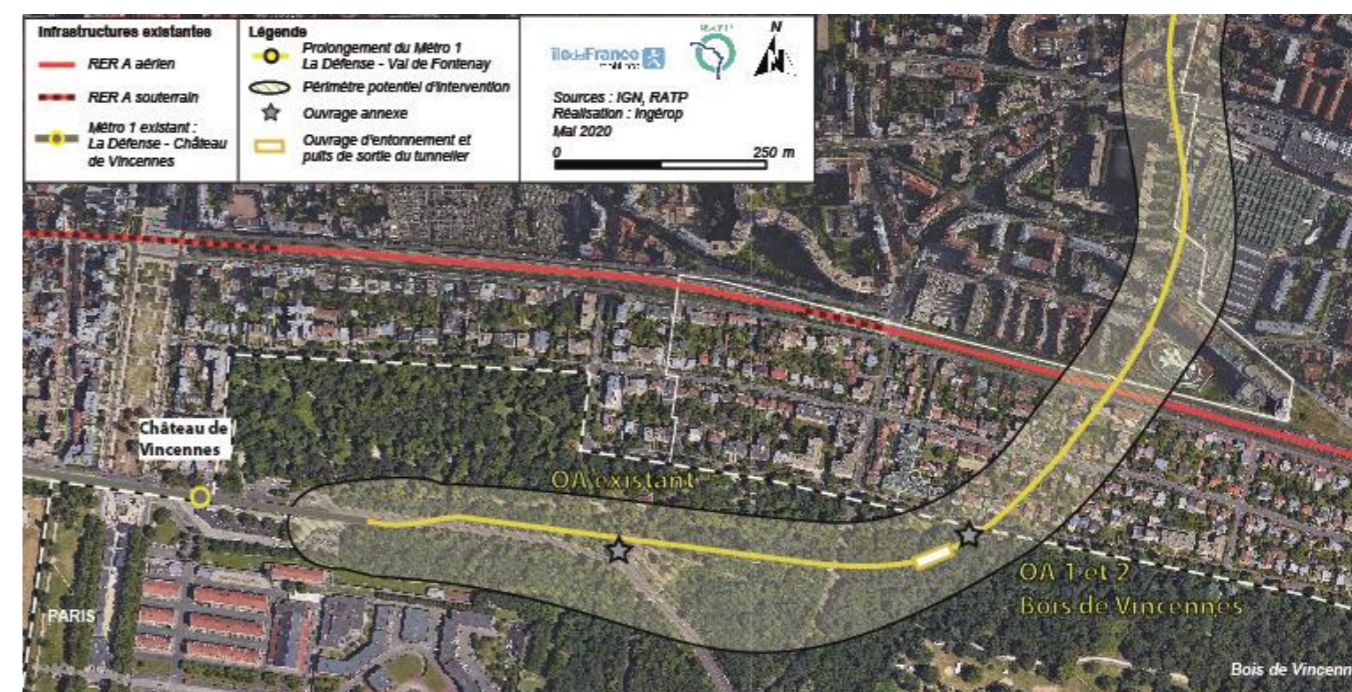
Extrait du PGT – Zoom sur le raccordement à l'existant (Source : Ingérop)
